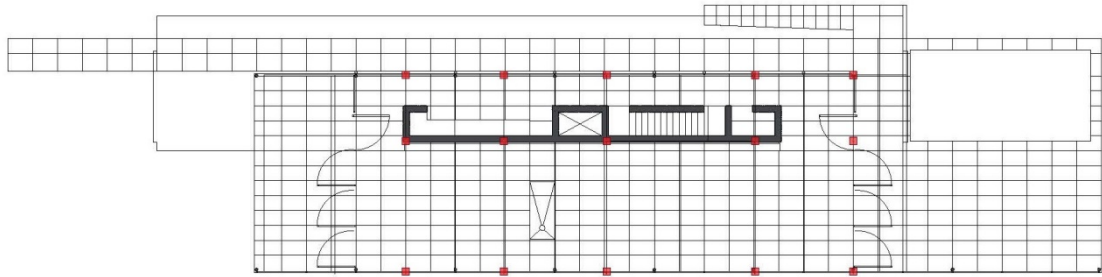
Planta Baja - "ARQ Ediciones – Mathias Klotz"
